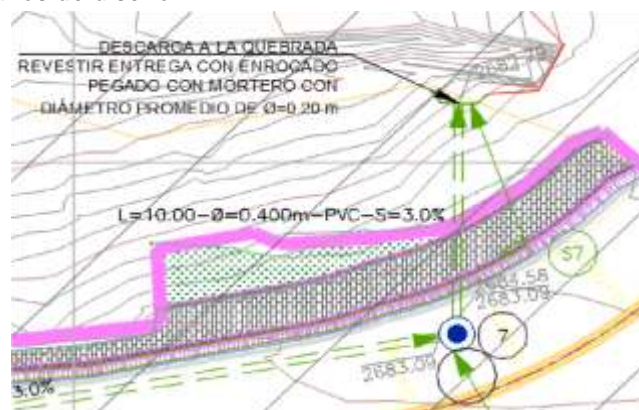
Sistema de Alcantarillado Pluvial Proyectado y Entrega a la Quebrada El Pilar
